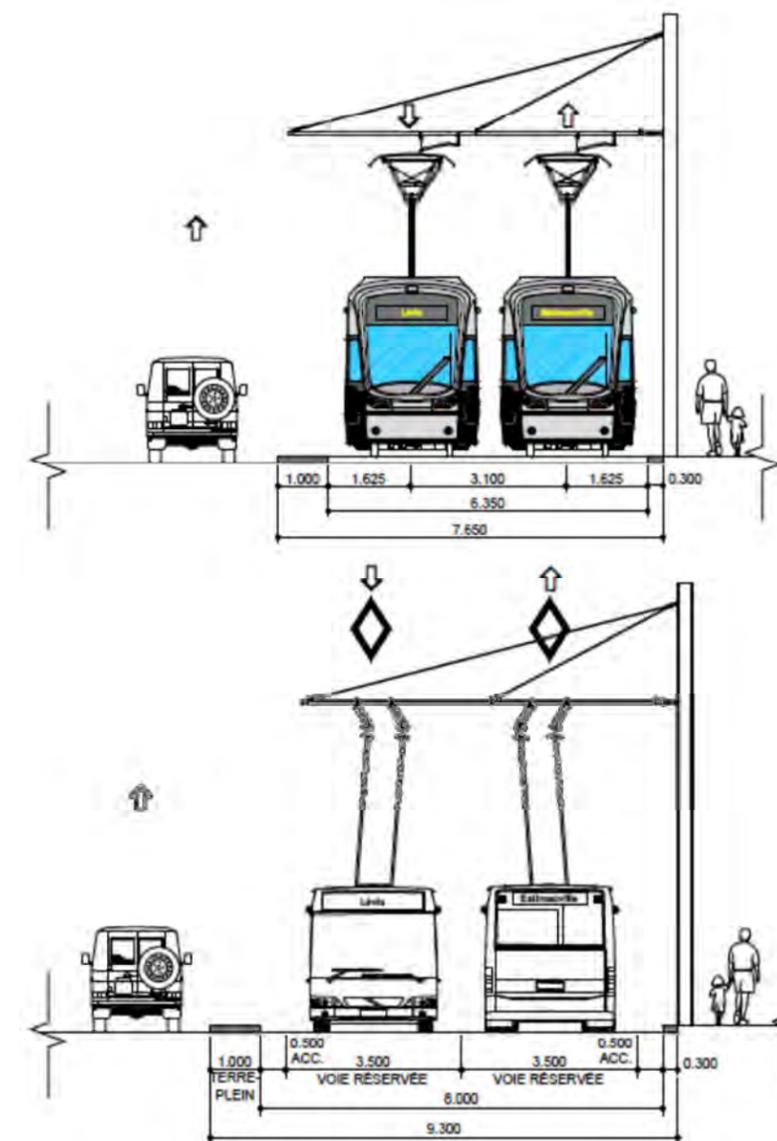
Coupe type 12 de 15 - SRB - Site propre standard - Insertion latérale
